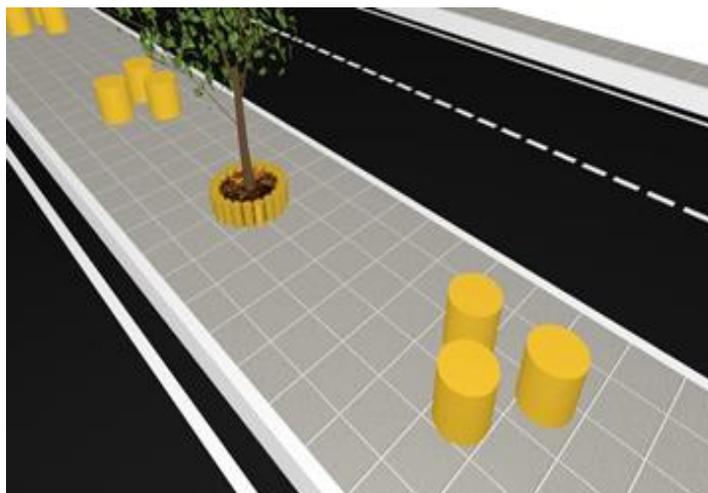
Canteiro central da Avenida Getúlio Vargas com as placas pré-moldadas de concreto com PET, vista em 3D.
